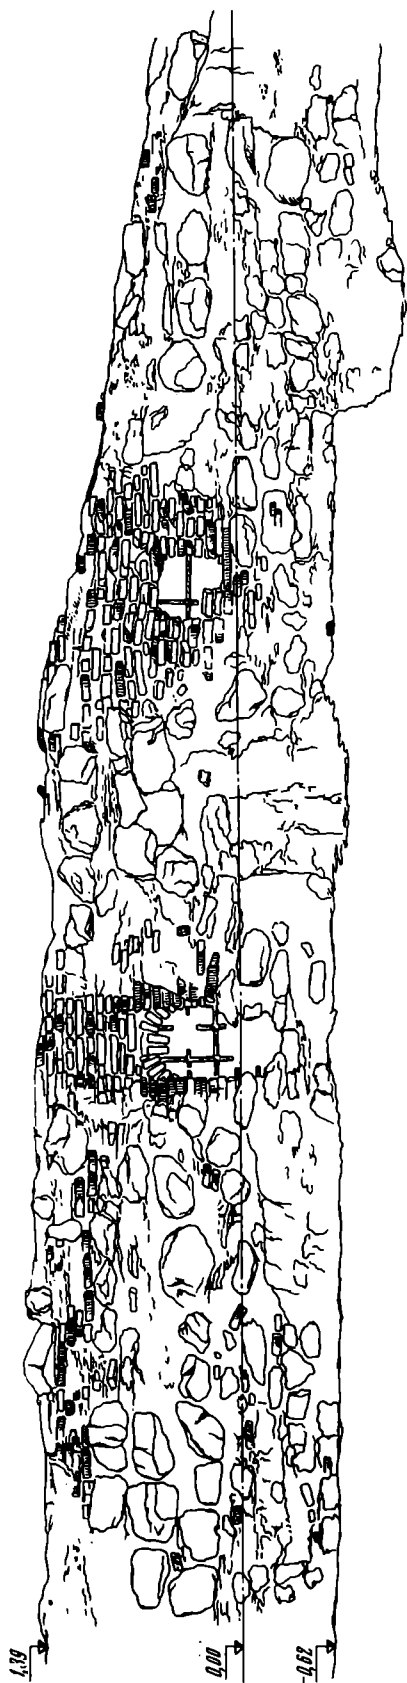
Фасад и план остатков юго-западной стены «дома на Роголице»
